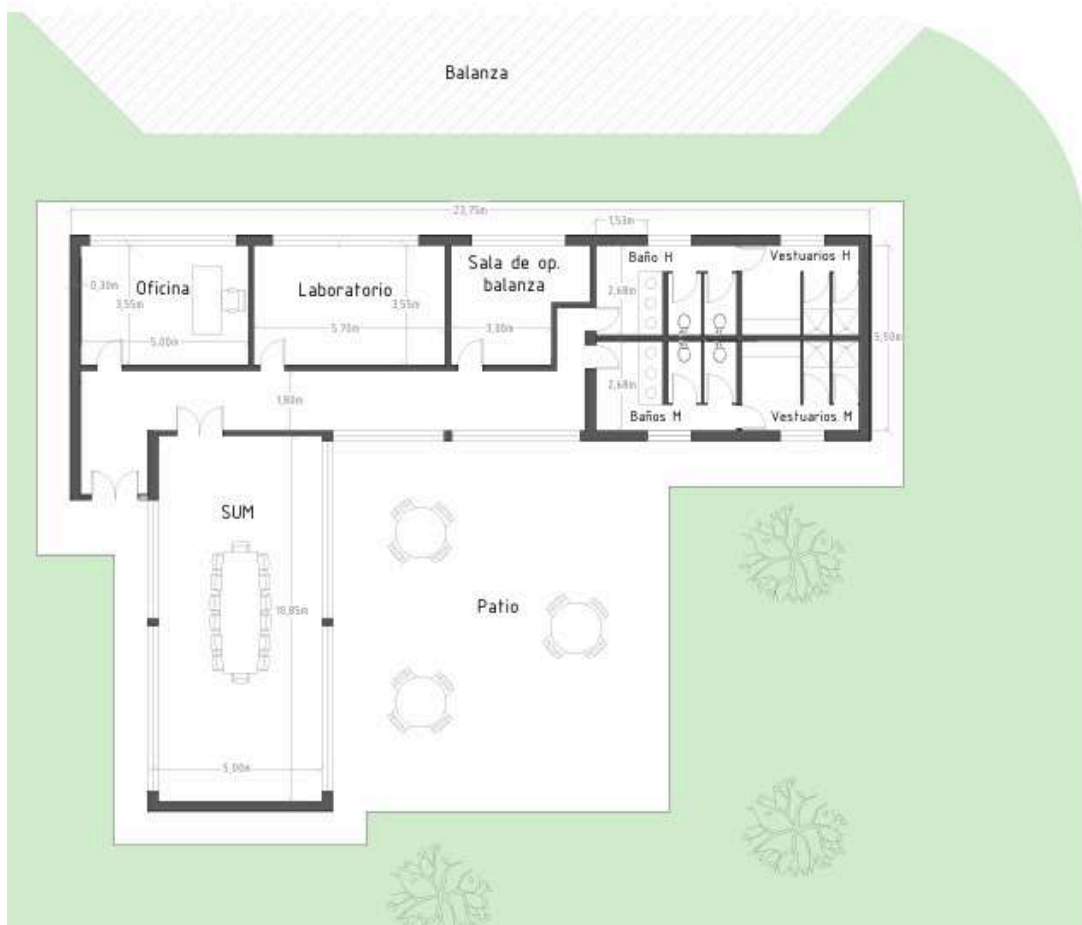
Edificio de ingreso. Plano arquitectónico
